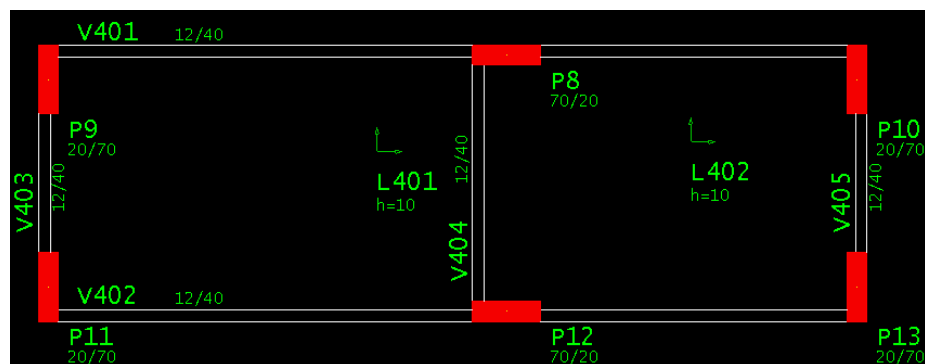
Planta de formas do teto da casa de máquinas (Fonte: Autor)
